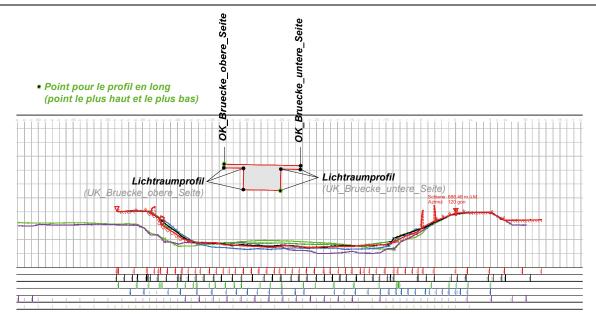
Exemple de profil en coupe, profil en travers GEWISS_Adr. 218566
